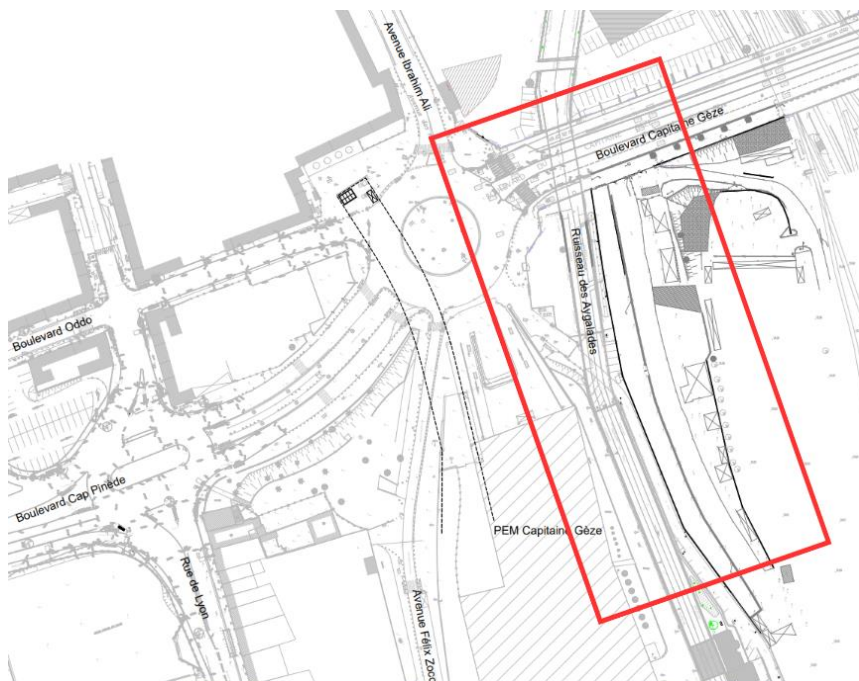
Plan de repérage des travaux de couverture du ruisseau des Ayalades (Source : Plan Topo de l'existant, Ingerop)
